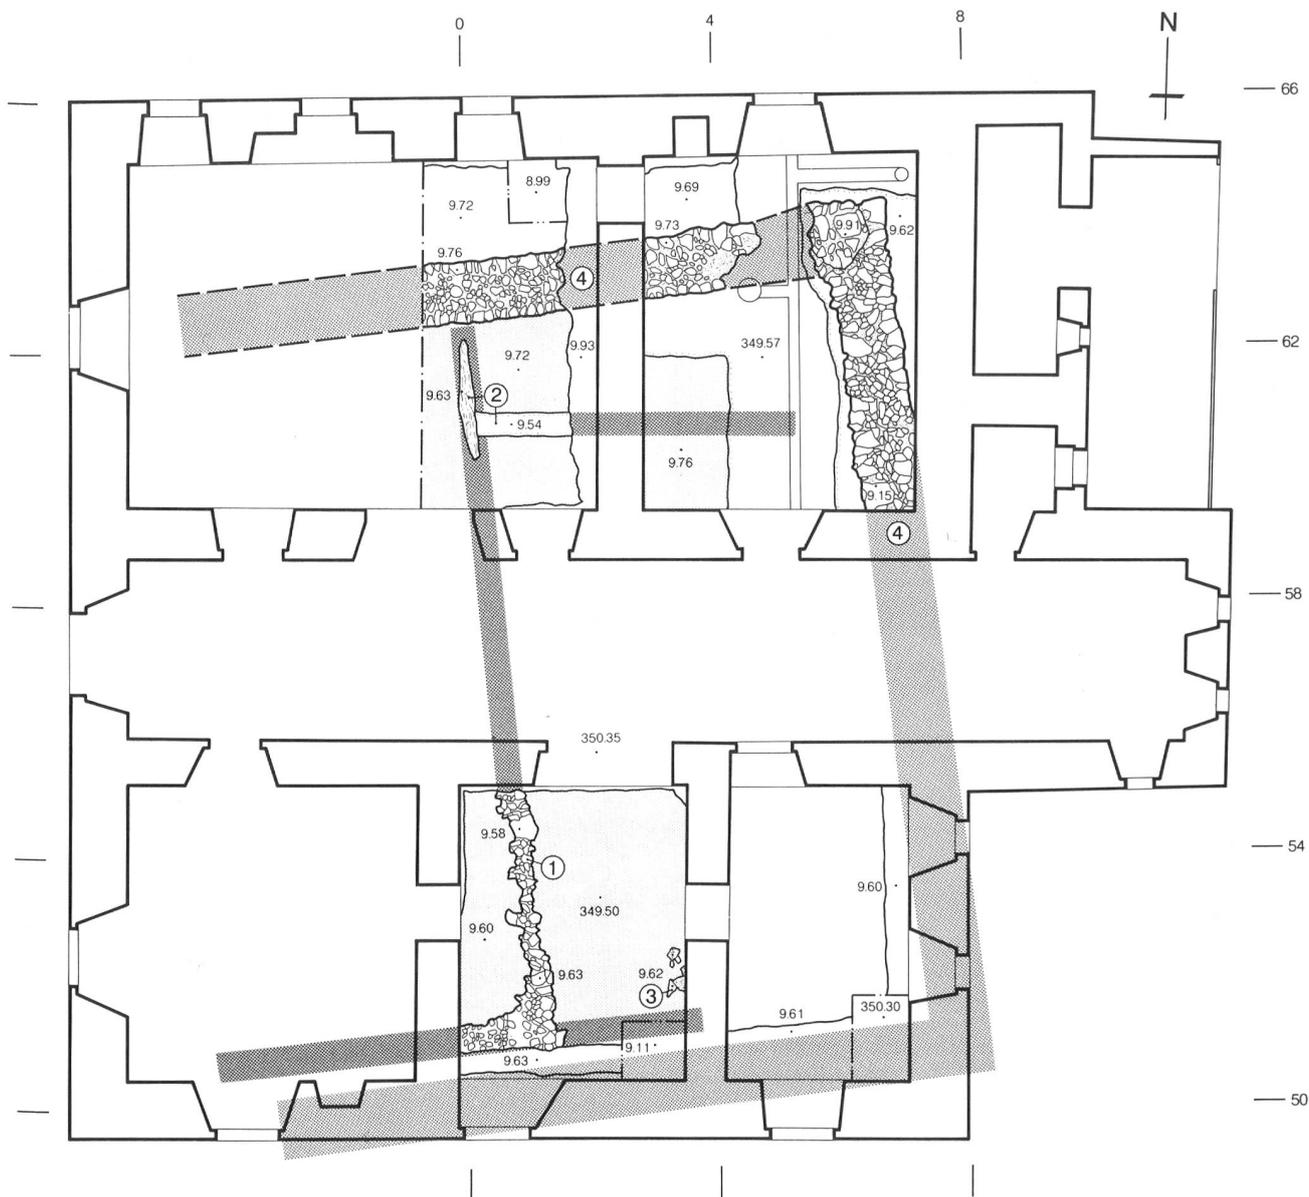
Laufen, Amtshaus. Grundriss der Grabungsbefunde. M. 1:150. 1 Steinreihen der Schwellenunterlagen, 2 Holzreste von Schwellen, 3 Feuerstelle zu Bau I, 4 Fundamente zu Steinbau II.
